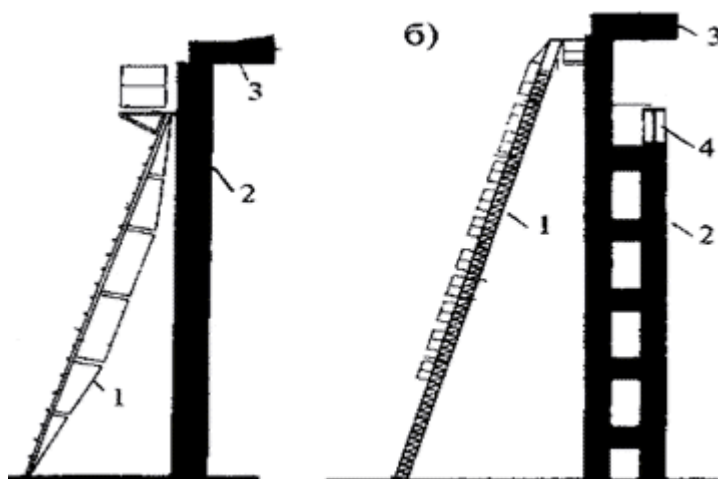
Монтажні сходи і підмостки, які застосовуються при монтажі арки
